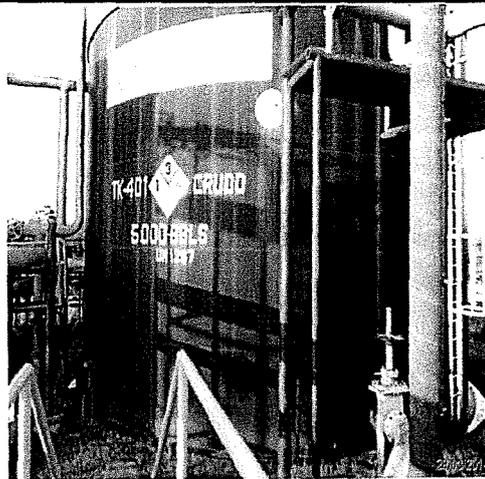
E0373809 N9724049/ Batería de Producción.
